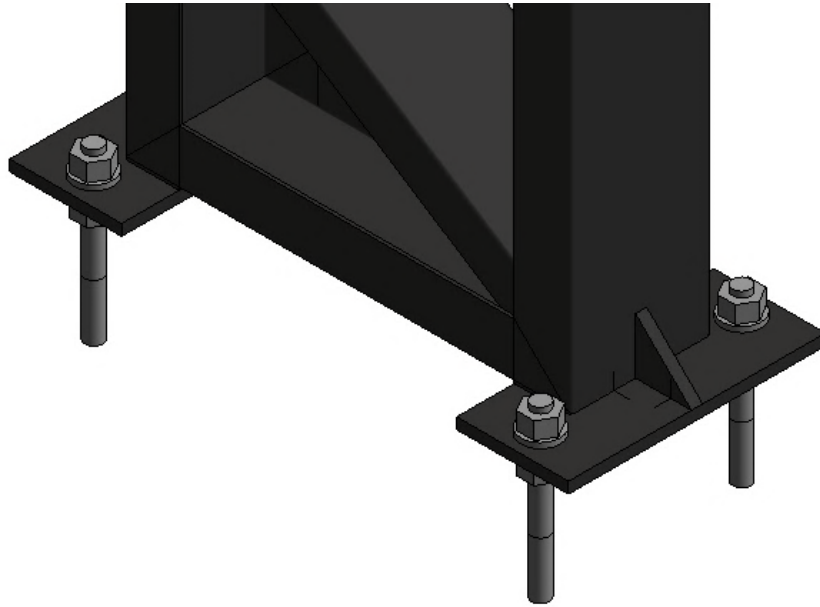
Vista tridimensional da ligação pilar | plinto no Revit 2020
